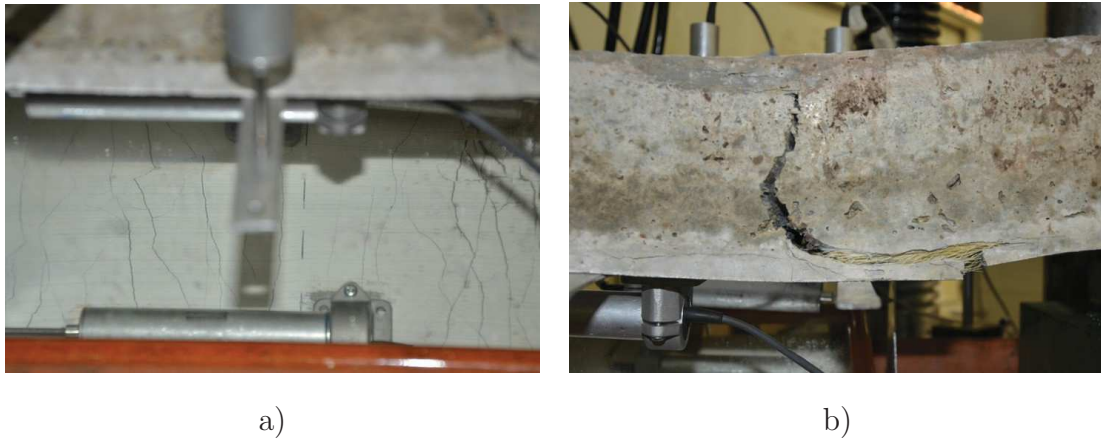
a) Fissuras na face inferior durante o ensaio b) Fissuração principal do núcleo
